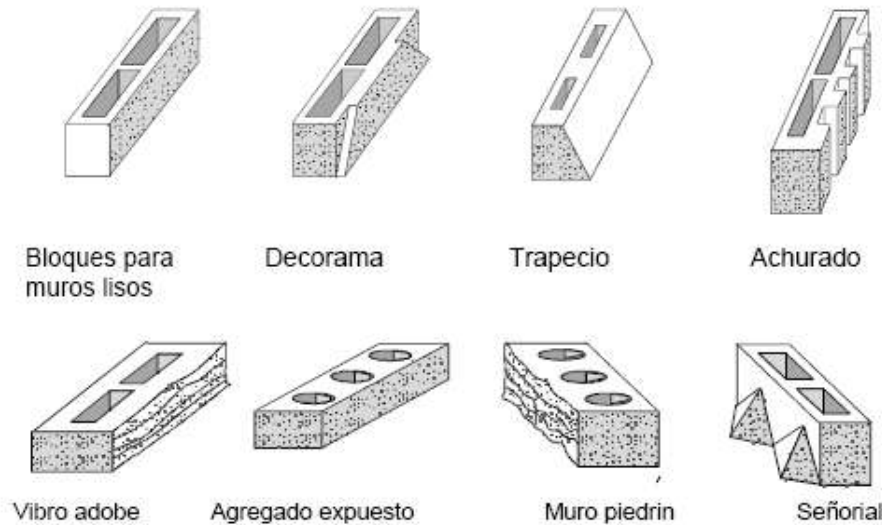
Tipos de piezas de mampostería [Robles, 1984]
